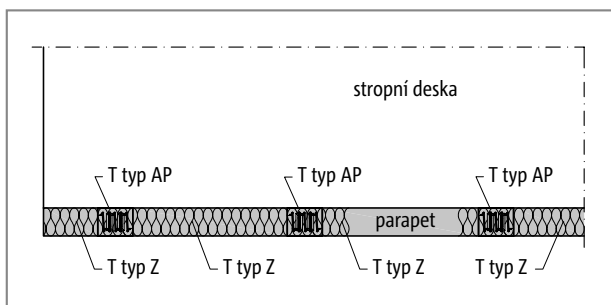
Schöck Isokorb® T typ AP - vodorovné zabudování: Pohled, předsazení parapetu resp. atiky
